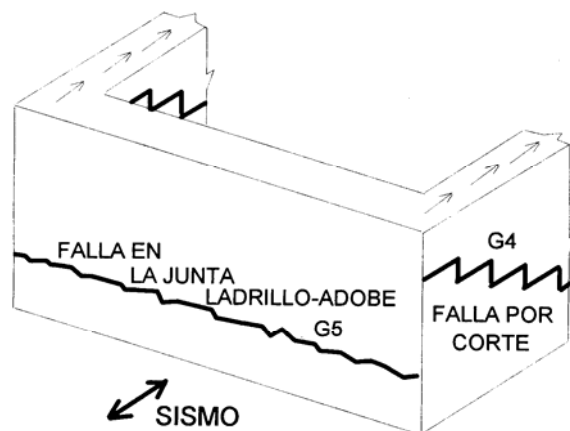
G4, fallas por cortante por carga sísmica en el plano del muro G5, falla de tipo horizontal entre el sobrecimiento y el muro de adobe (Ref. 1)
